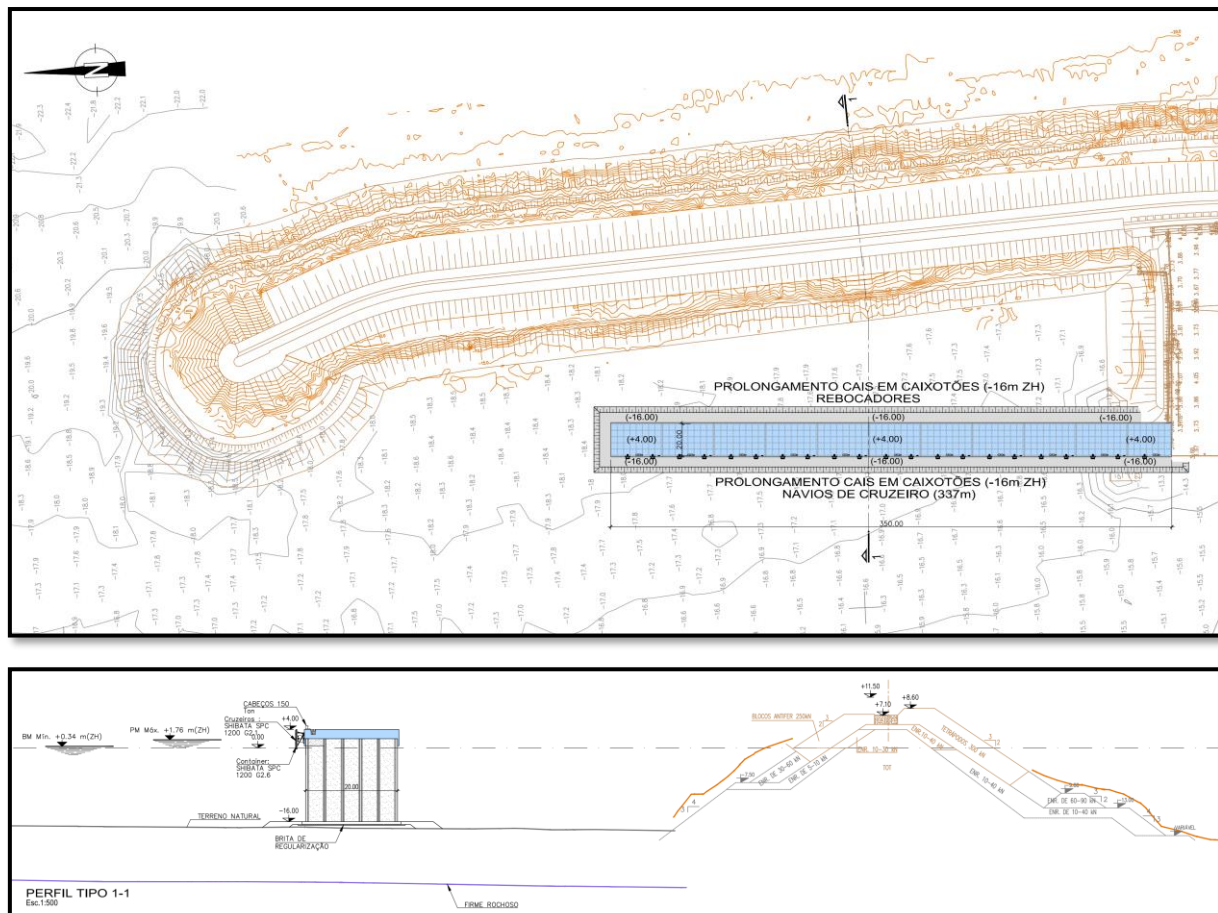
Prolongamento do cais existente à -12m(ZH) – SOLUÇÃO 2 (planta e perfil tipo)
